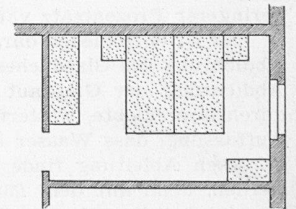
Das ist die Schlafzimmermöbel, die die Architekten in diesem Falle in den Grundriss einzeichneten
